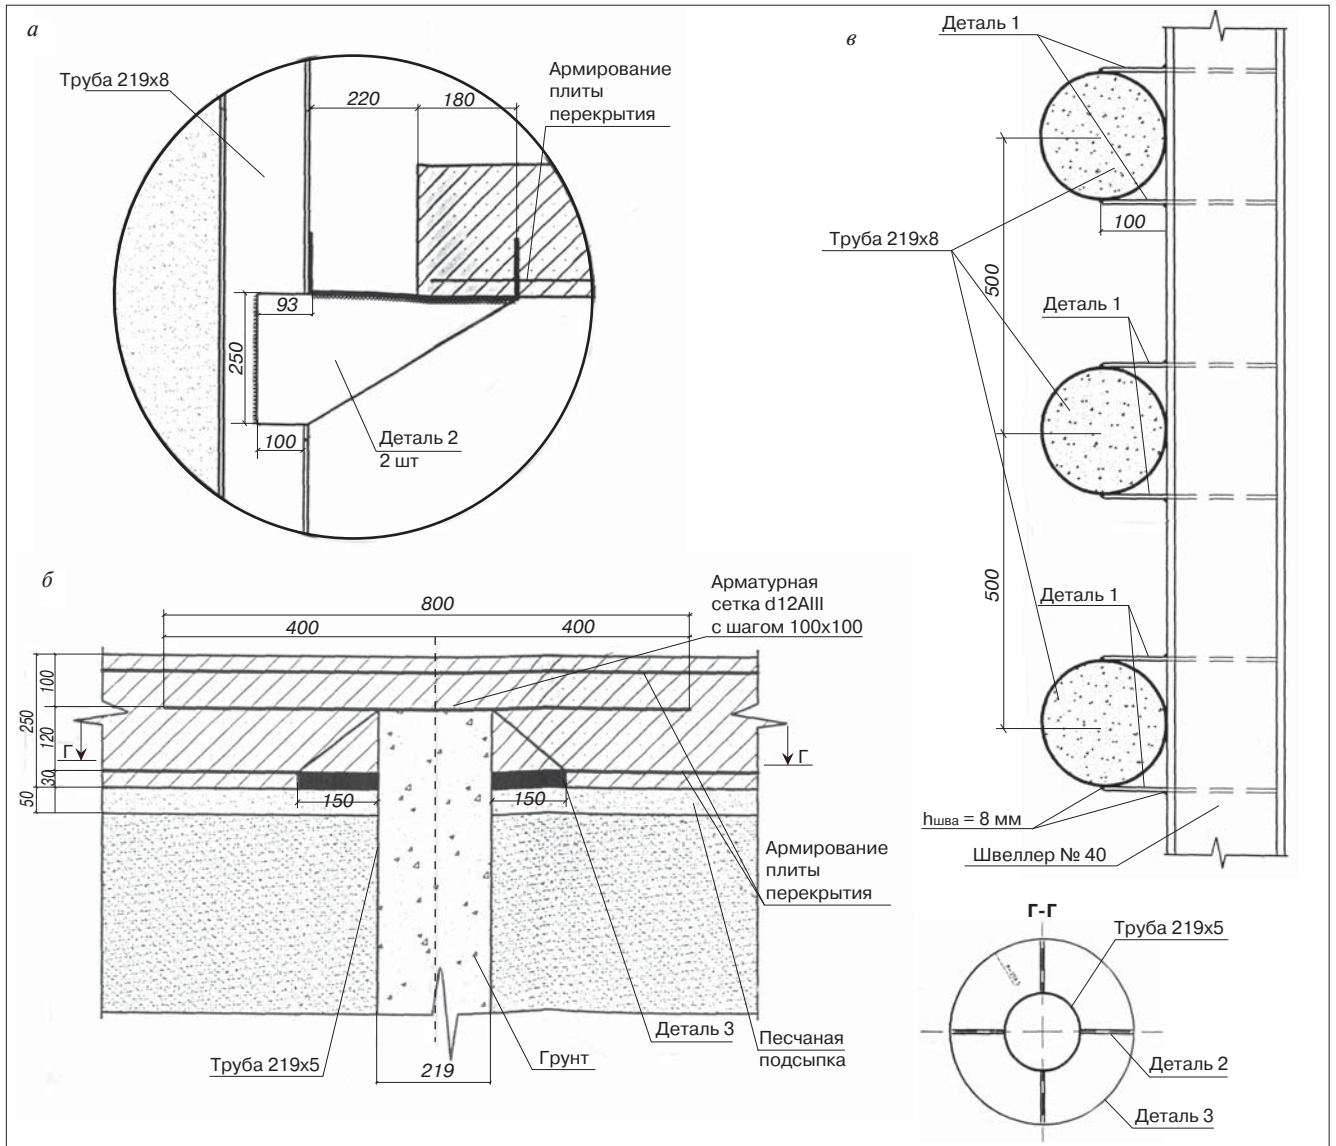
Узлы сопряжения временных свай и шпунта с перекрытием: а – временное крепление плиты перекрытия к ограждению котлована; б – временное крепление плиты перекрытия к сваям; в – конструкция распределительной балки
